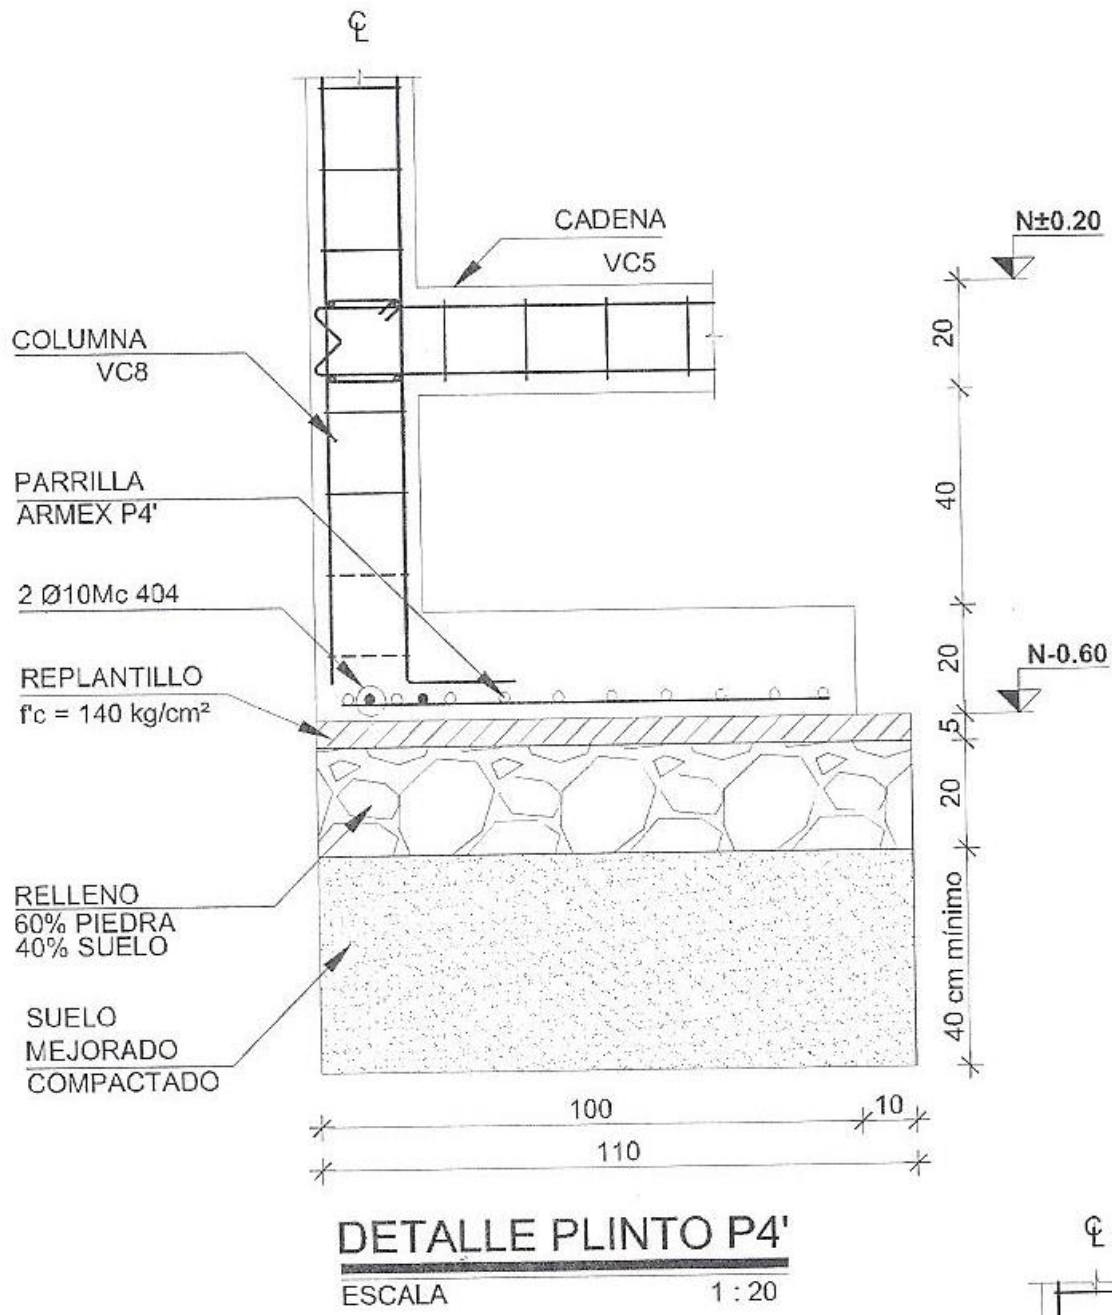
Detalle de Plinto P'4 utilizado para la cimentación
